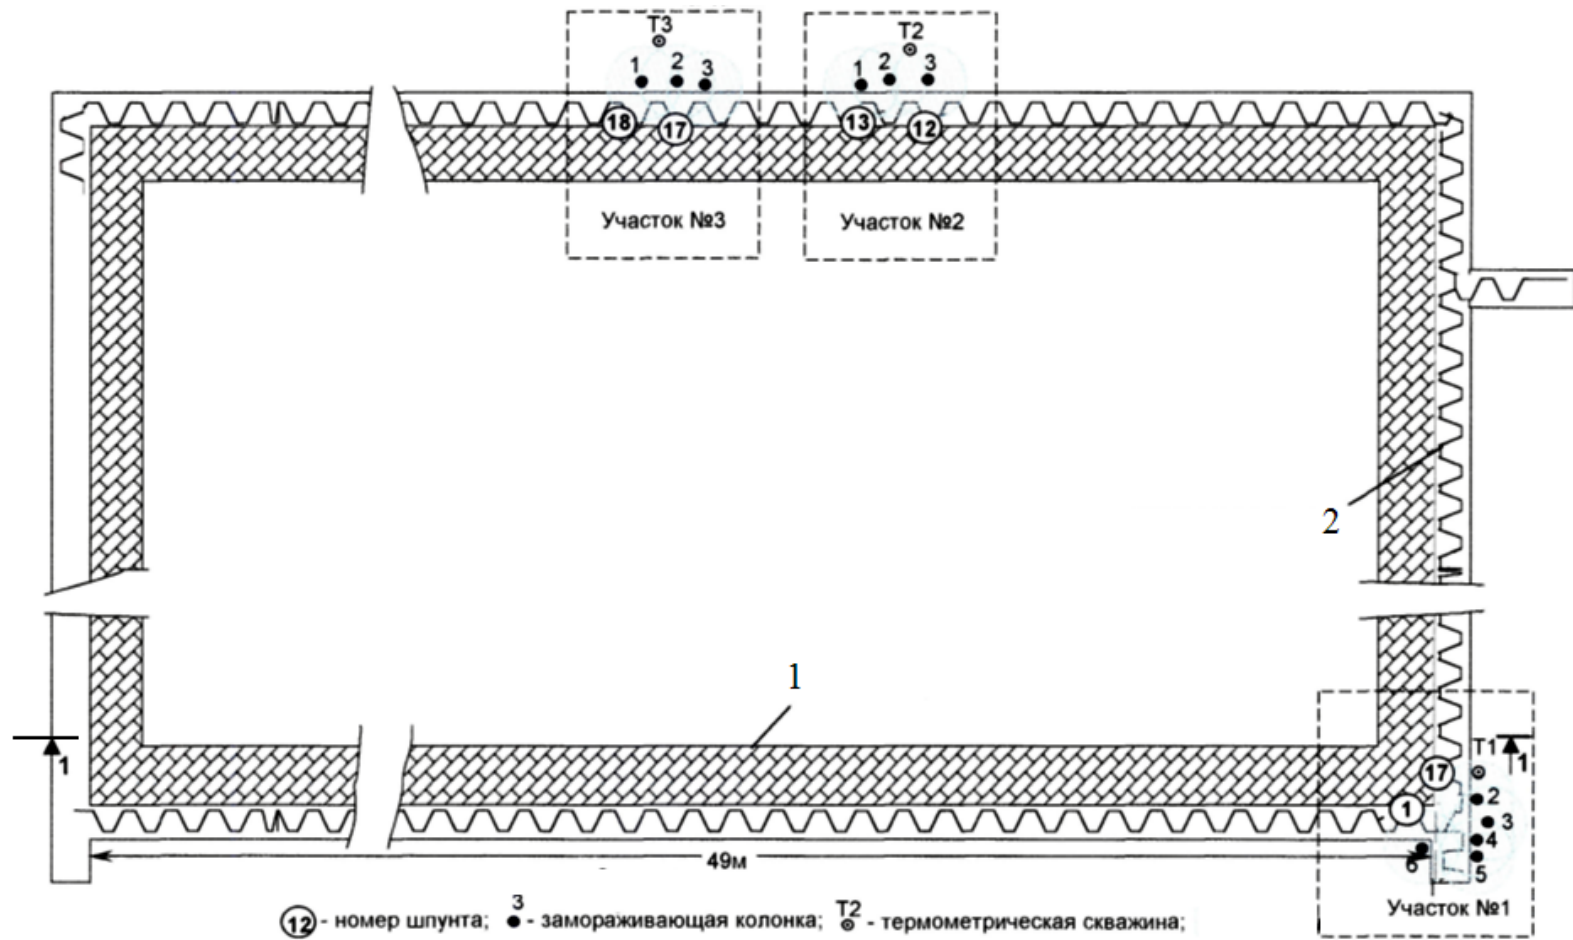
Замораживание грунтов при строительстве Лефортовского тоннеля в г. Москве. План монтажной камеры[45]: 1 – железобетонная стена монтажной камеры; 2 – шпунтовое ограждение. Участки № 1–3 – места производства работ по замораживанию грунта
